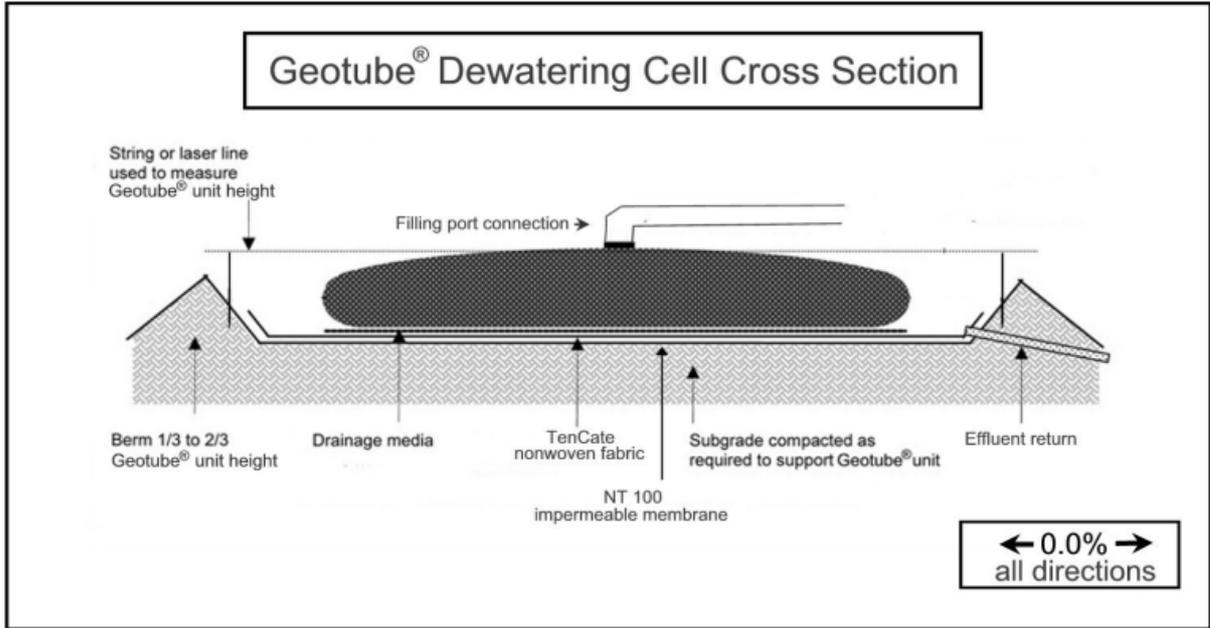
Vista en corte de pretil requerido para instalación de geotubos. Se requiere dimensiones 32 x 22 m.
